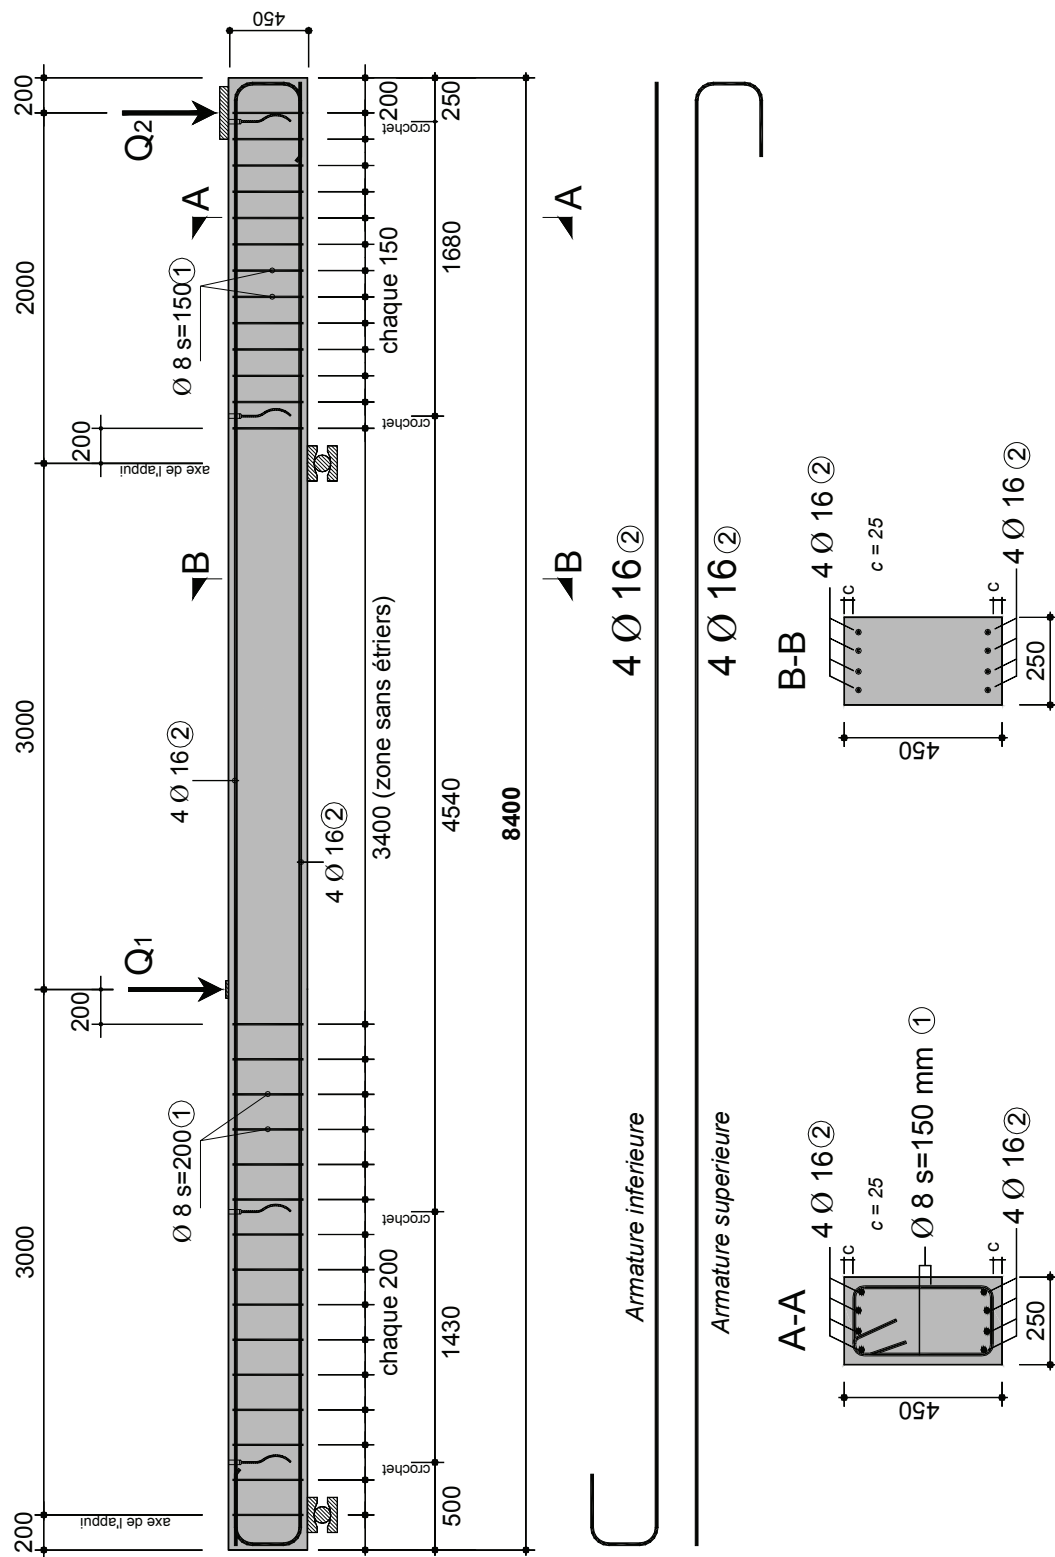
Dimensions des bandes de dalle et armature [mm]
